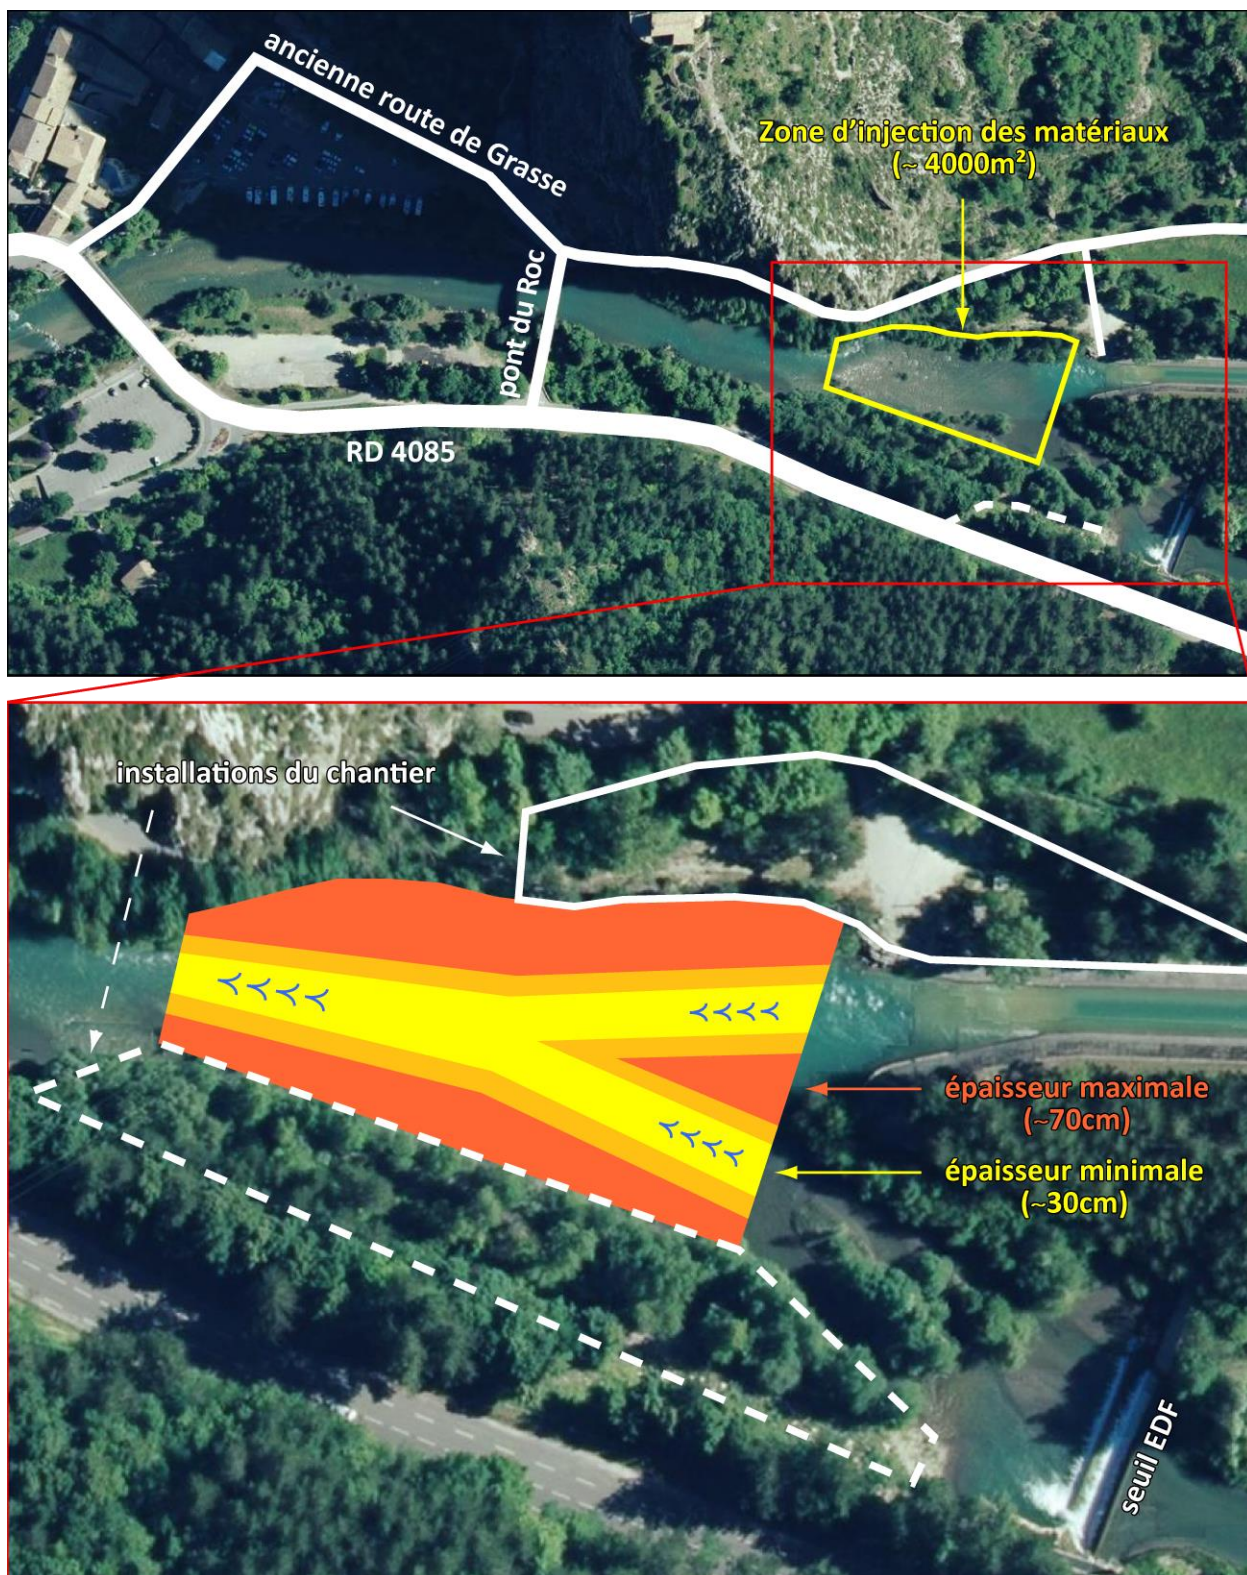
Vue en plan du site d'injection n°1 et de l'injection proposée
